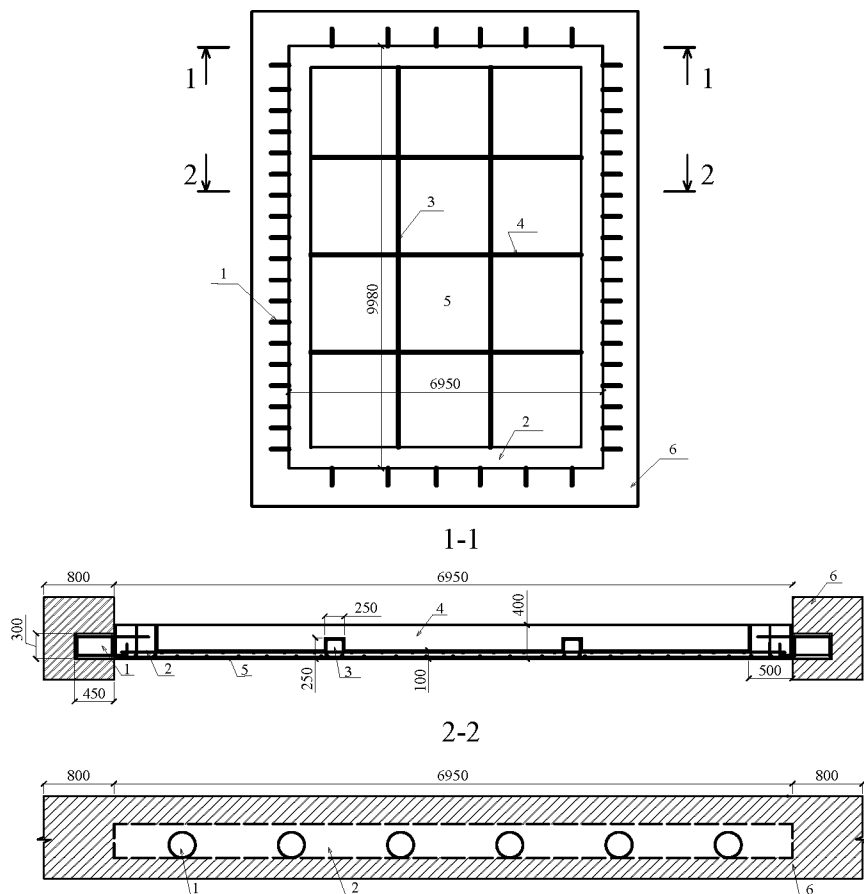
Схема выполнения разновидности реконструкции фундаментной системы путем подведения сплошной монолитной железобетонной плиты:
